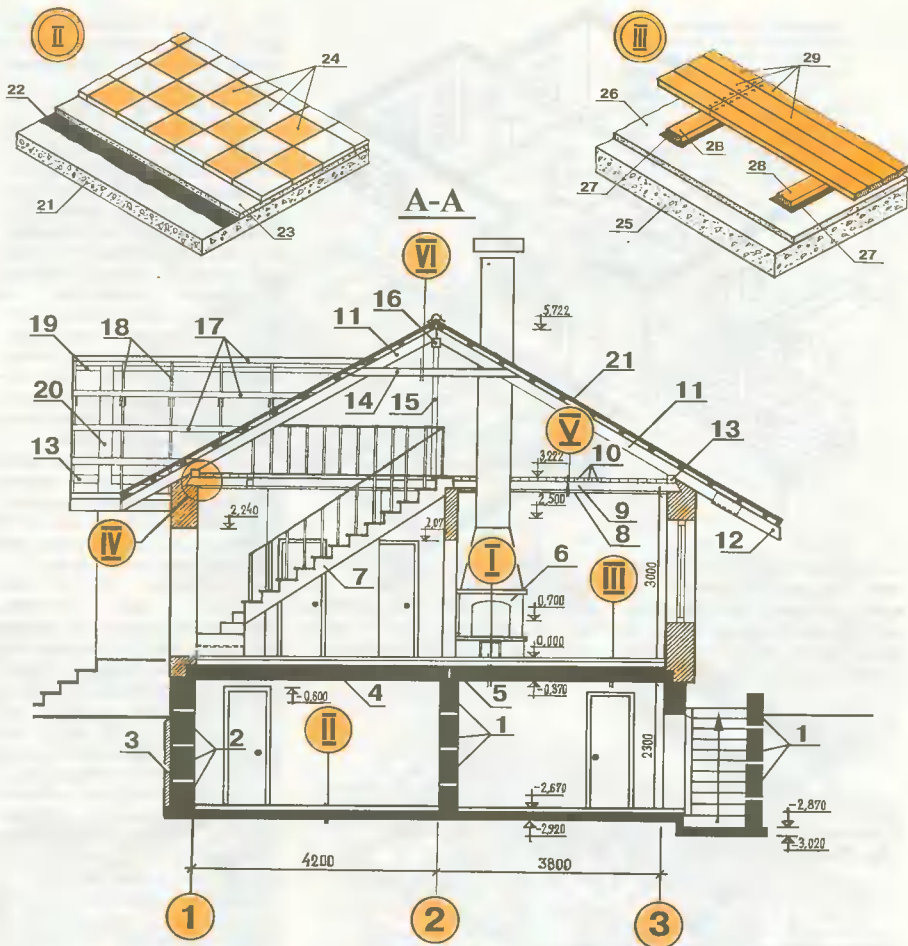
Разрез дома А-А (см. рис. 3): 1 — фундаментные блоки ФБС-24.3.6; 2 — фундаментные блоки ФБС-24.4.6; 3 — защитная стенка оклеенной гидроизоляции; 4, 5 — плиты перекрытия подвала; 6 — камни; 7 — лестница; 8 — подшив потолка; 9 — несущие балки чердачного перекрытия; 10 — дощатый настил чердака; 11 — стропила; 12 — кобылки; 13 — мауэрлит; 14 — ригель; 15 — стойка под козырьковый брус; 16 — козырьковый брус; 17 — обрешетка; 18 — стропила козырька над входом; 19 — козырьковый брус козырька над входом; 20 — фронтон козырька над входом; 21 — бетонная подготовка; 22 — гидроизоляция; 23 — цементная стяжка; 24 — армированная бетонная плитка; 25 — железобетонные плиты перекрытия подвала; 26 — выравнивающая цементная стяжка; 27 — толь; 28 — лага; 29 — шпунтованная половая доска.
